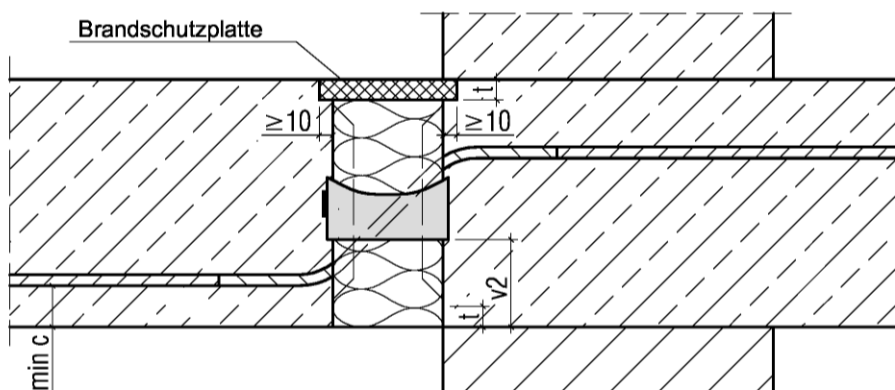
Schöck Isokorb® Typ Q (Ausführungsvariante C) gem. Abschnitt 3.1.2
